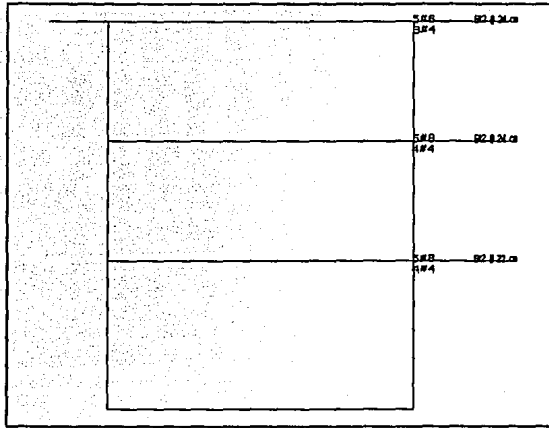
Armados de las vigas del eje 2, modelo 3, Q=2
